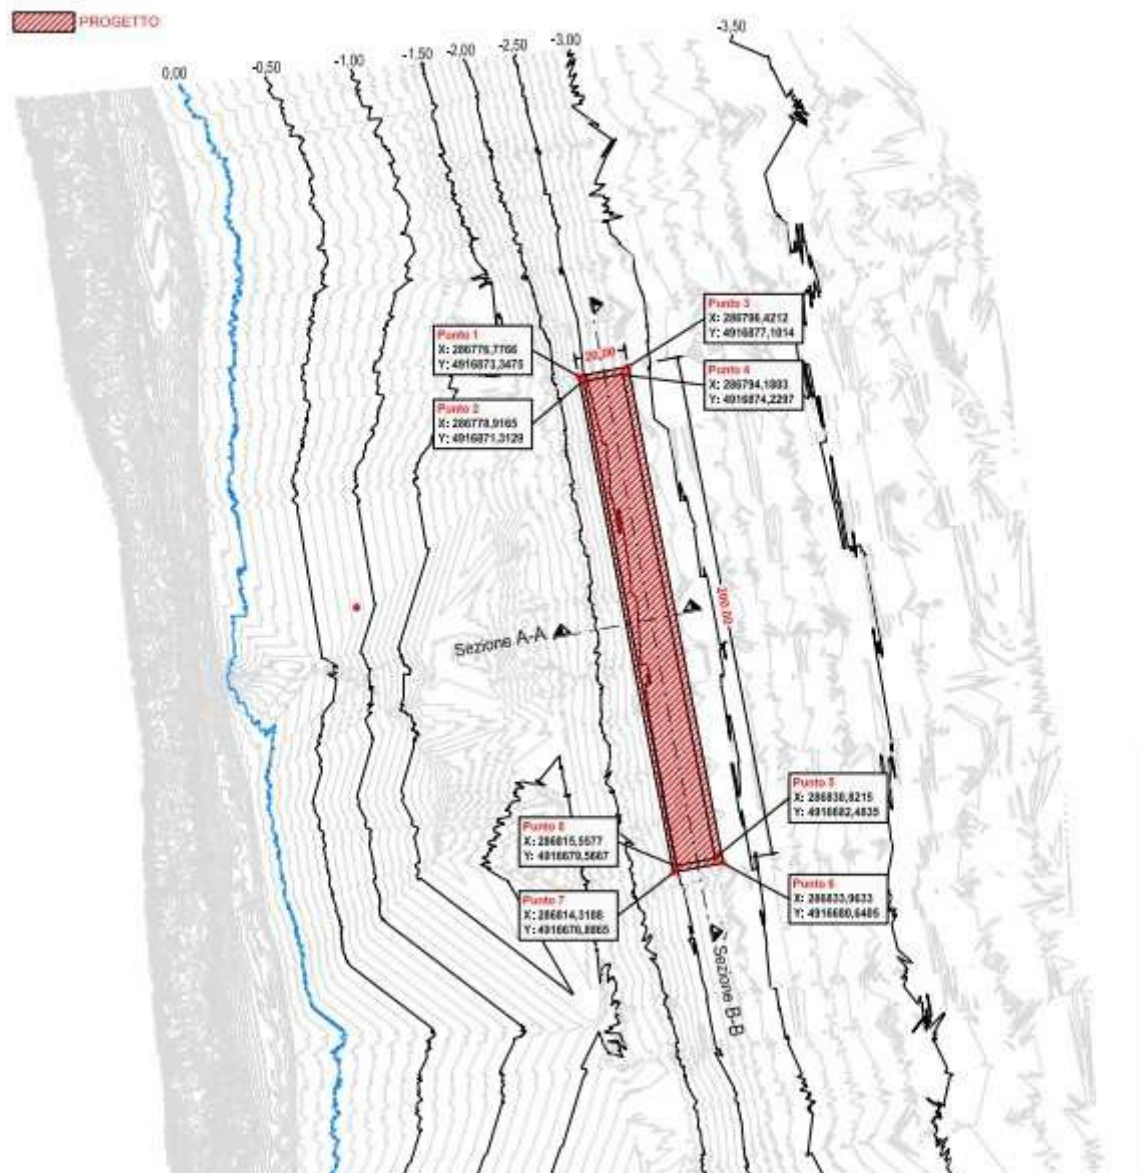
Planimetria di possibile collocamento della struttura Rigida;
